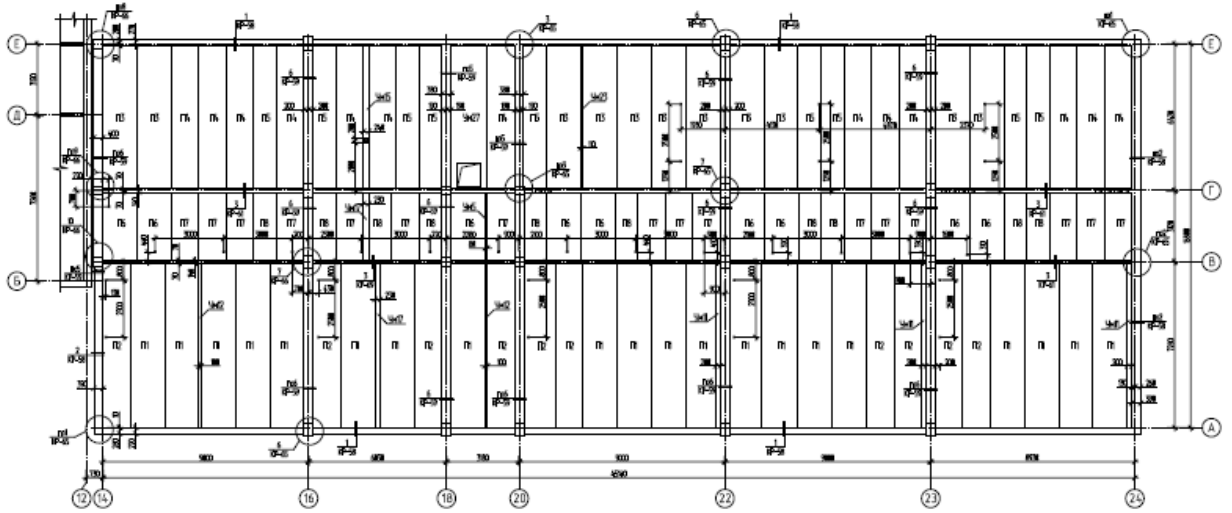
Схема расположения плит перекрытия и антисейсмического пояса на отм. + 6,300 в осях А-Е, 14-24
